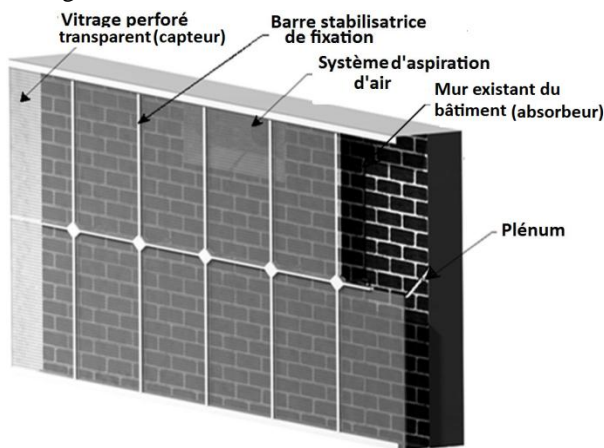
Schéma d'un TTC installé sur un mur de briques
